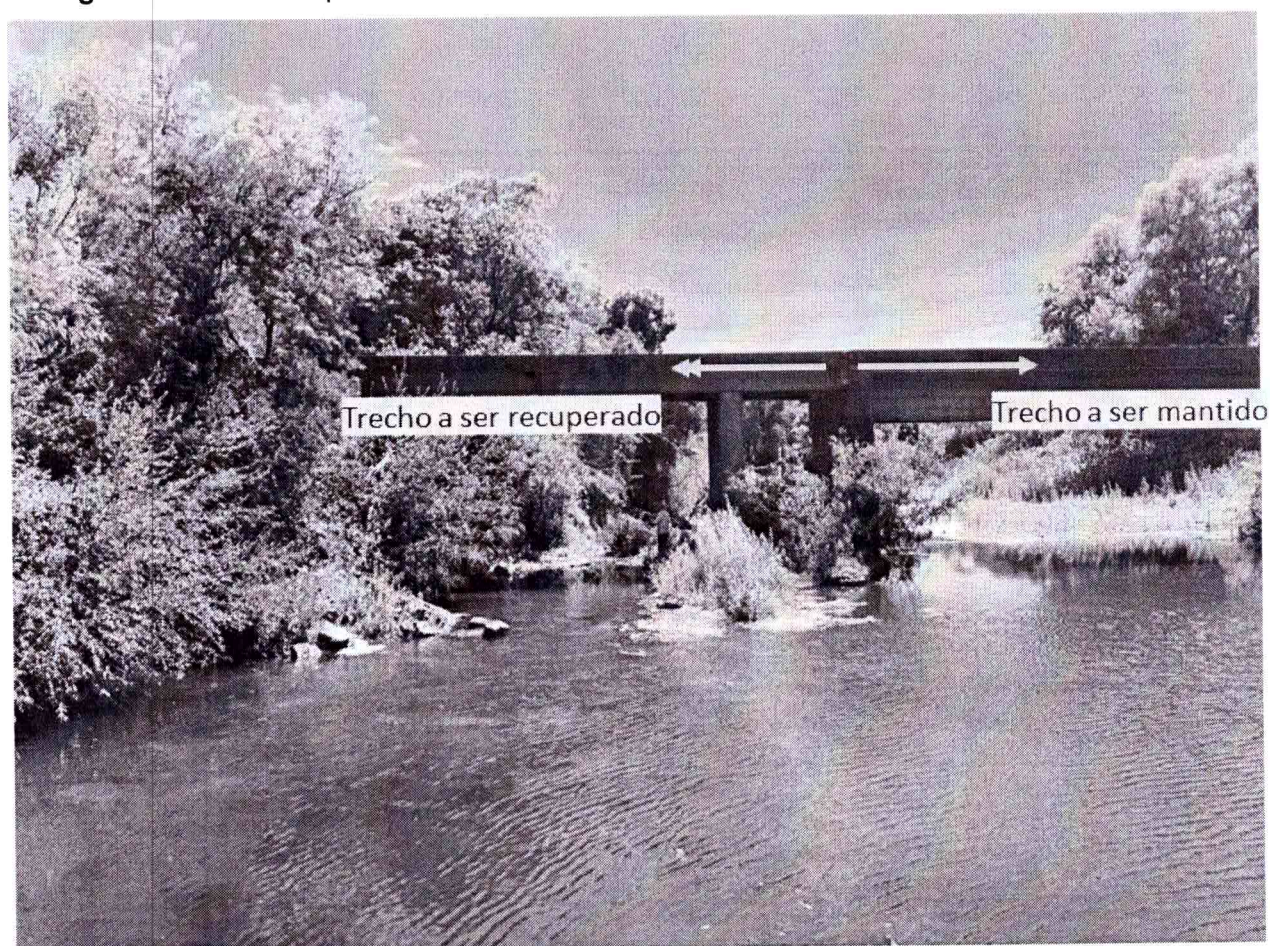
Vista Lateral da Ponte sobre o Arroio Ituzinho. (Foto Eng Thiago Piovezan)
